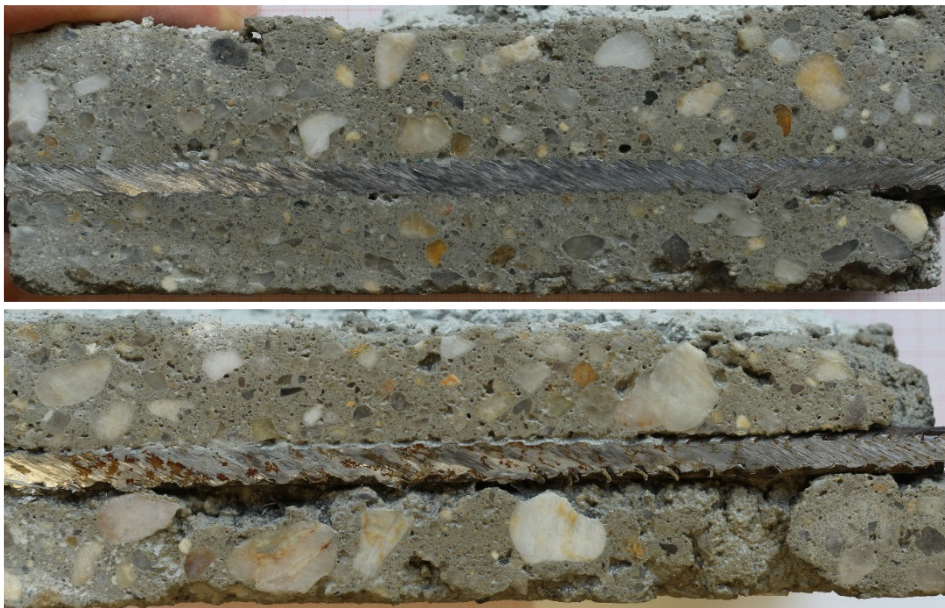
Längsschnitte mit horizontaler Bewehrungslage; 10 mm Betonstahl
